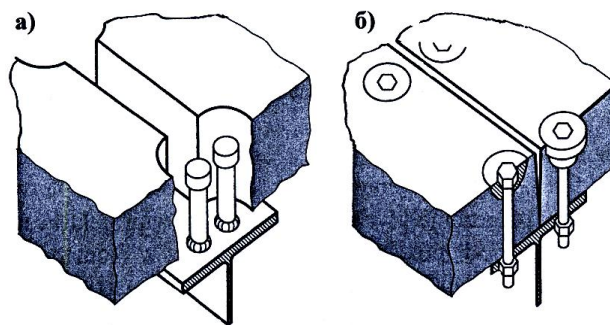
Объединение перфорированных сборных железобетонных плит с металлическими балками с помощью анкерных стержней (а) и напрягаемых высокопрочных болтов (б) [10]
